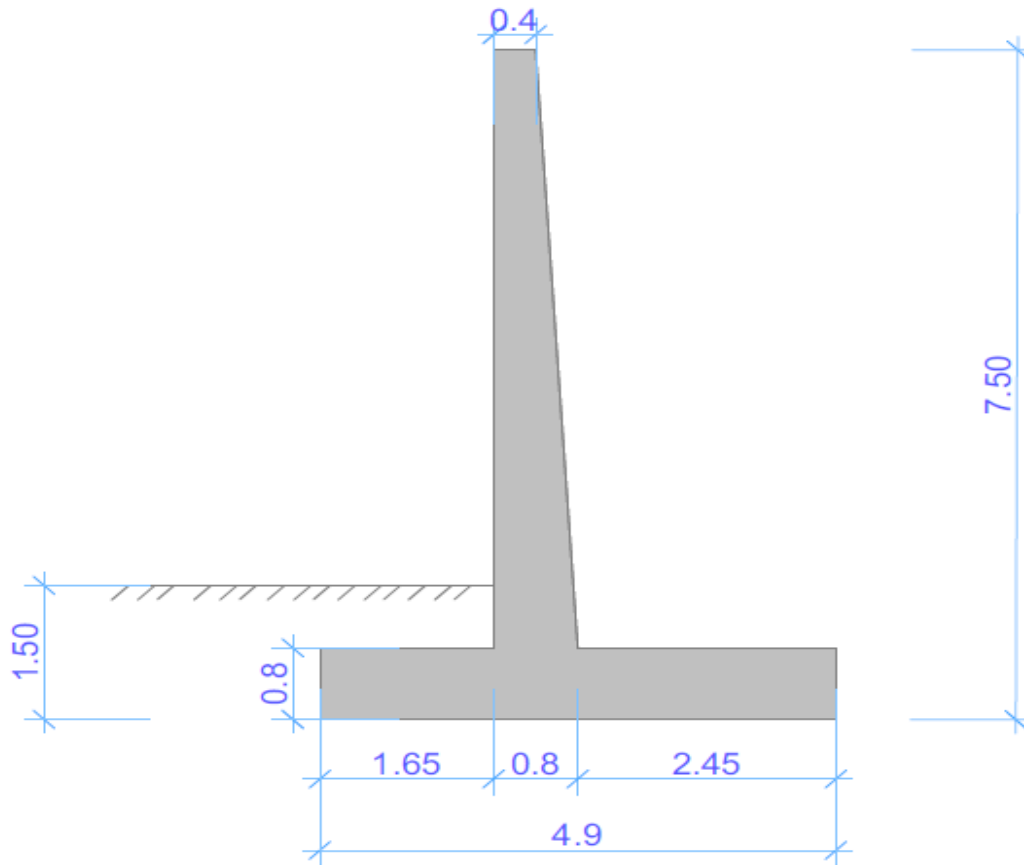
Pré-dimensionnement du mur de soutènement étudié.
